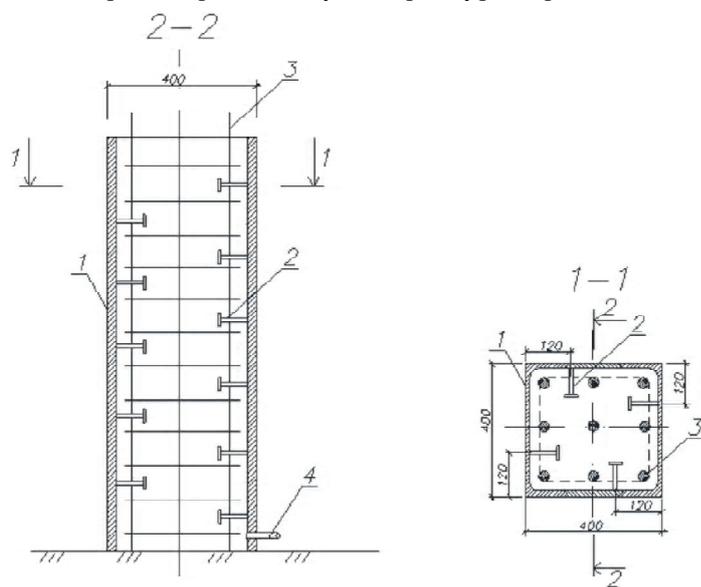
Монтаж опалубки сталежелезобетонной колонны:
